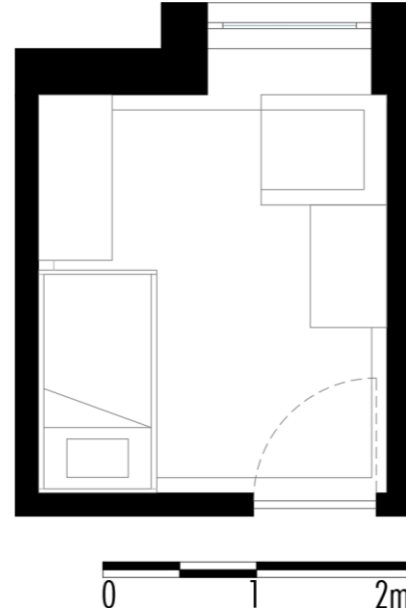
Planta de estudo de *layout* 2 (Fonte: Autora, 2024)
